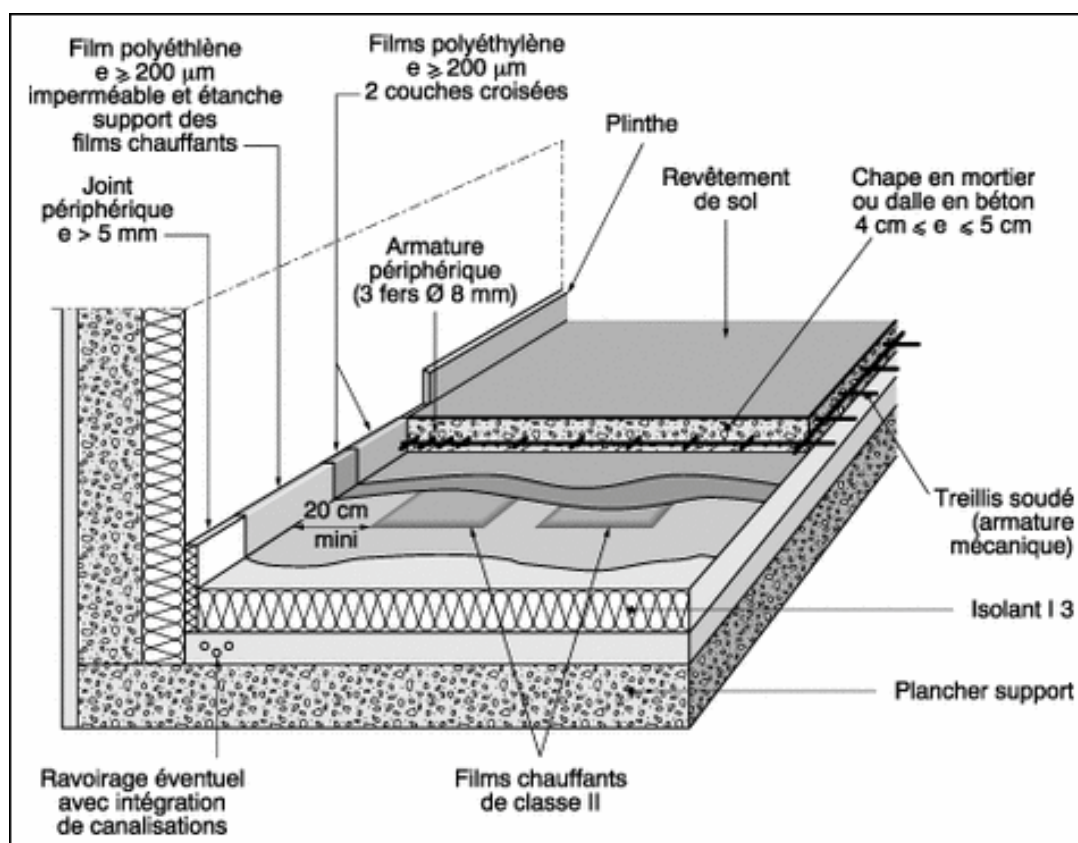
Film chauffant reposant sur un isolant compressible, recouvert par une chape en mortier ou une dalle en béton destinée à recevoir un revêtement de sol collé
